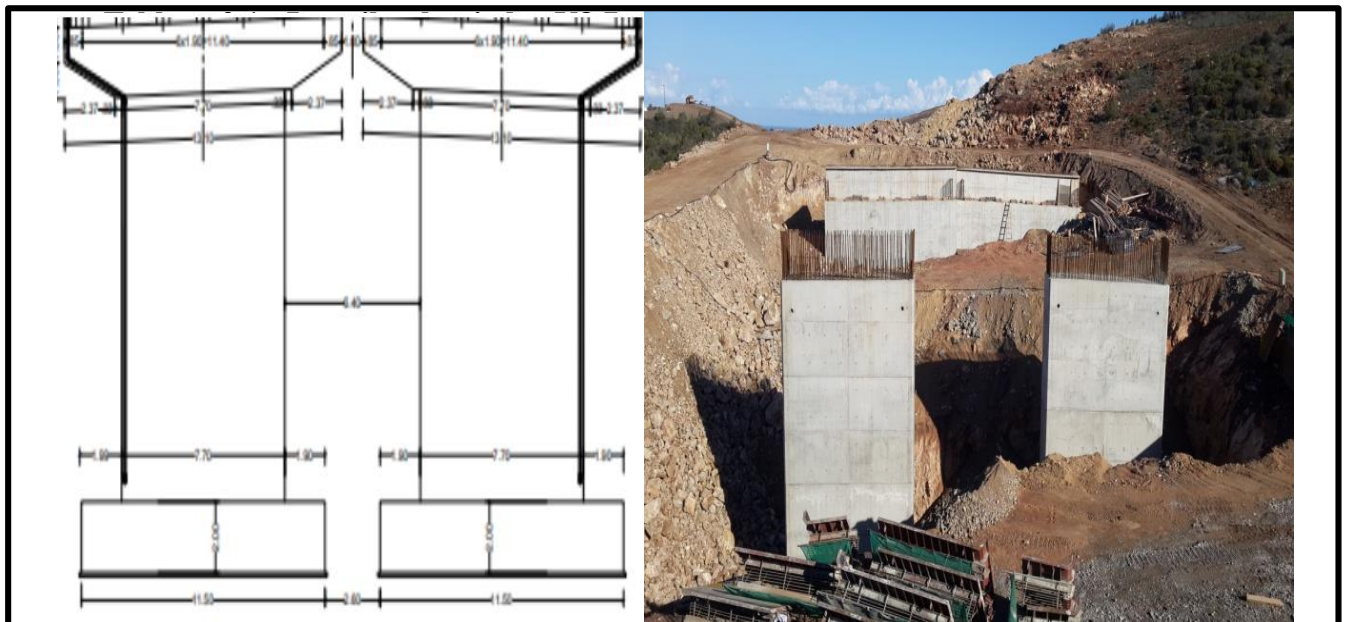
13 : Coupe transversale et une photo de pile pleine
